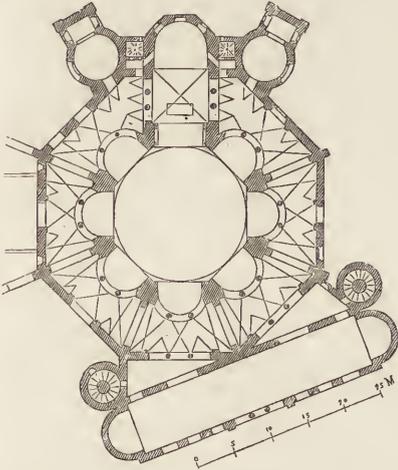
Grundriss von S. Vitale zu Ravenna.
